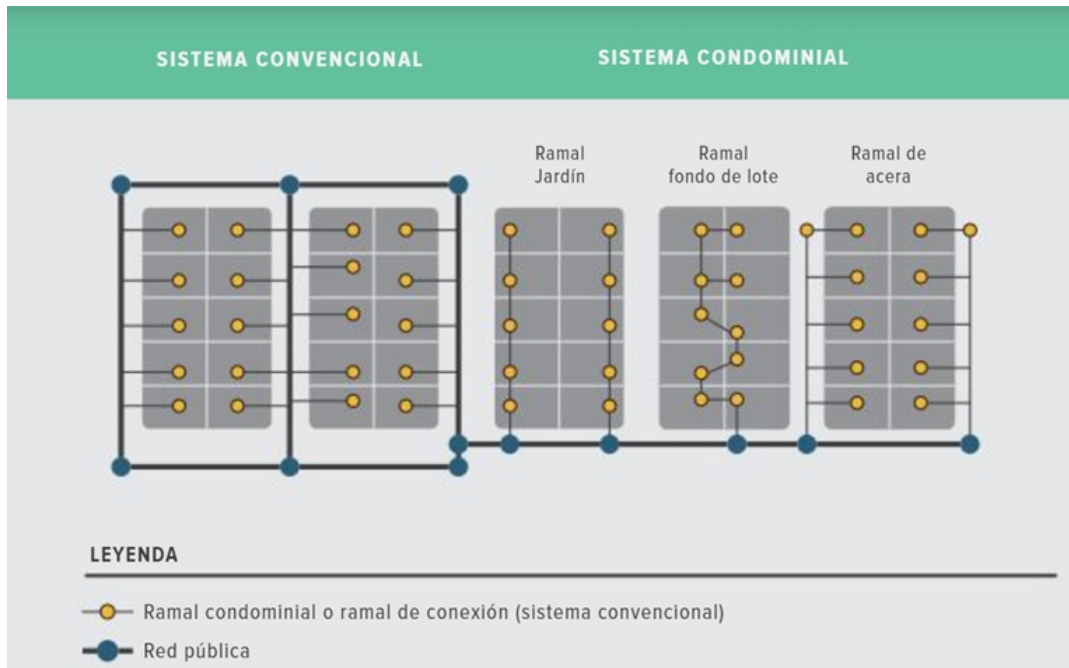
Sistemas de Alcantarillado en Planta (Plascencia, 2014)
